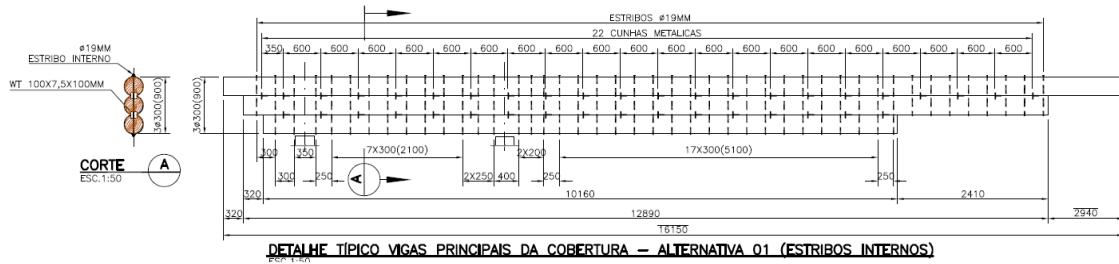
Desenho da viga composta (principal) do pórtico detalhando a alternativa de união utilizada na edificação.
